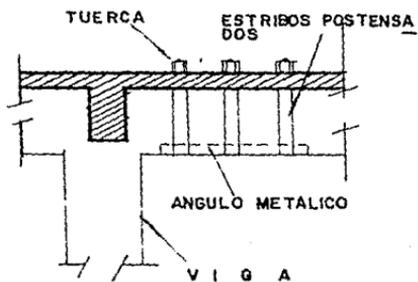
VIGA REFORZADA CON ESTRIBOS ADICIONALES EXTERIORES (POSTENSADOS)
